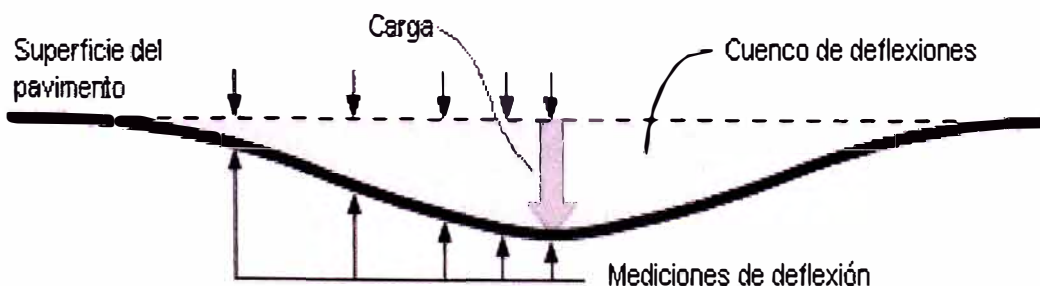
Esquema del cuenco de deflexiones del pavimento.
